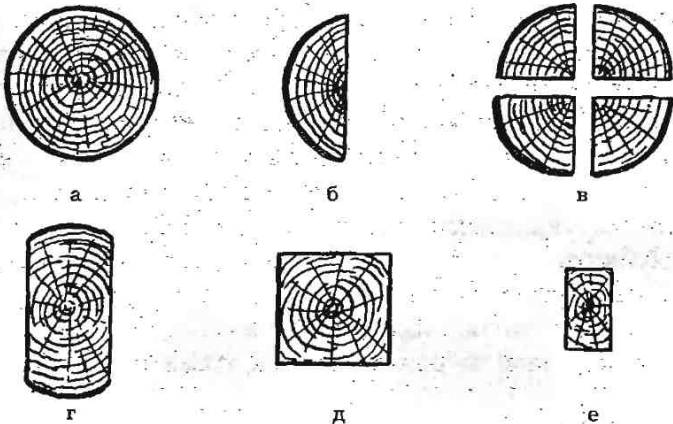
Поперечные срезы строительной древесины: а — кряж, подвязник, жердь; б — пластина; в — четвертина; г — лежень, или брус с обзолом; д — брус; е — брусок
